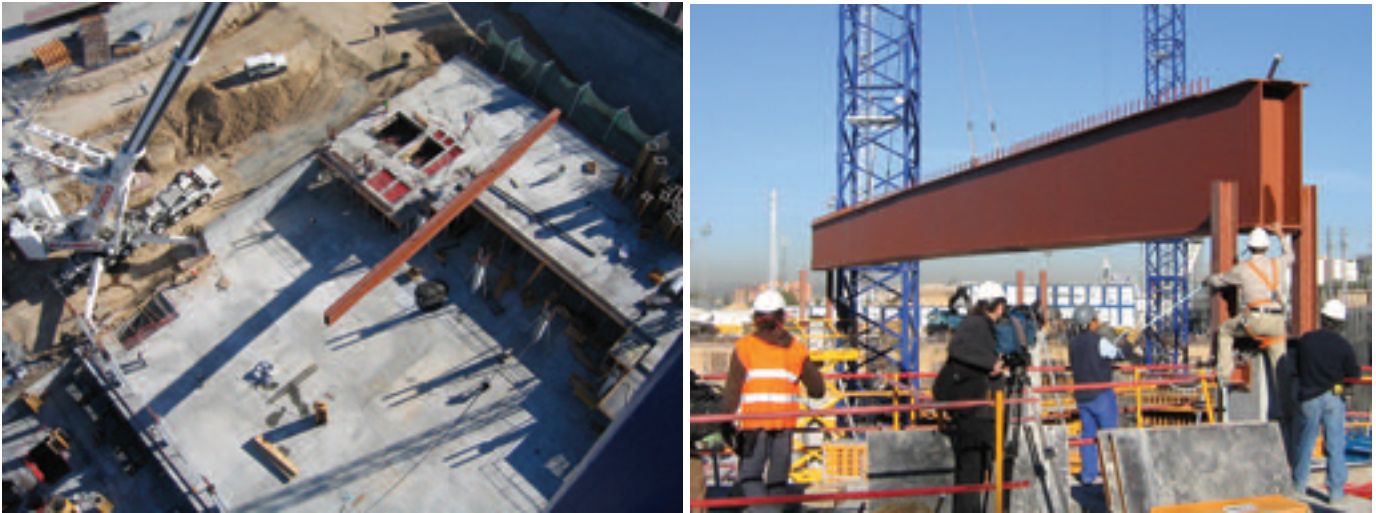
Montaje de las vigas metálicas para el cubrimiento del salón de convenciones.
